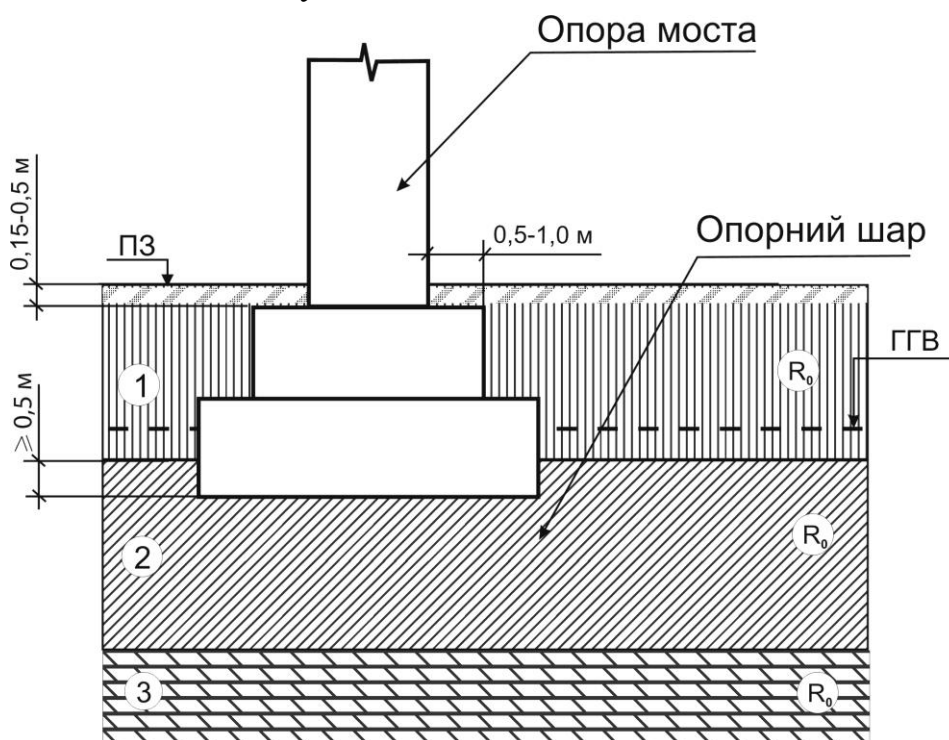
Конструкція фундаменту мілкового закладення на суходолі
